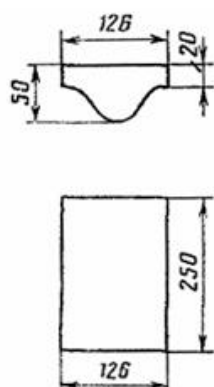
Сборные бетонные и асфальтобетонные лотки типа I
